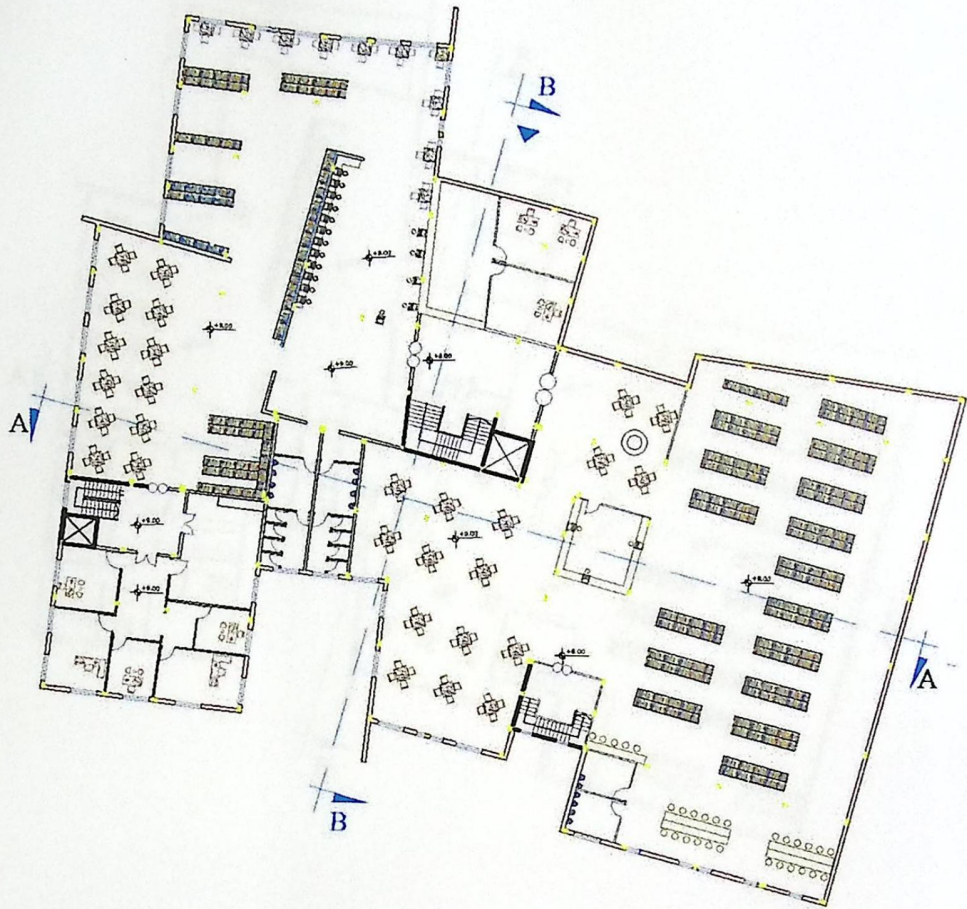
المسقط الأفقي للطابق الأرضي.
